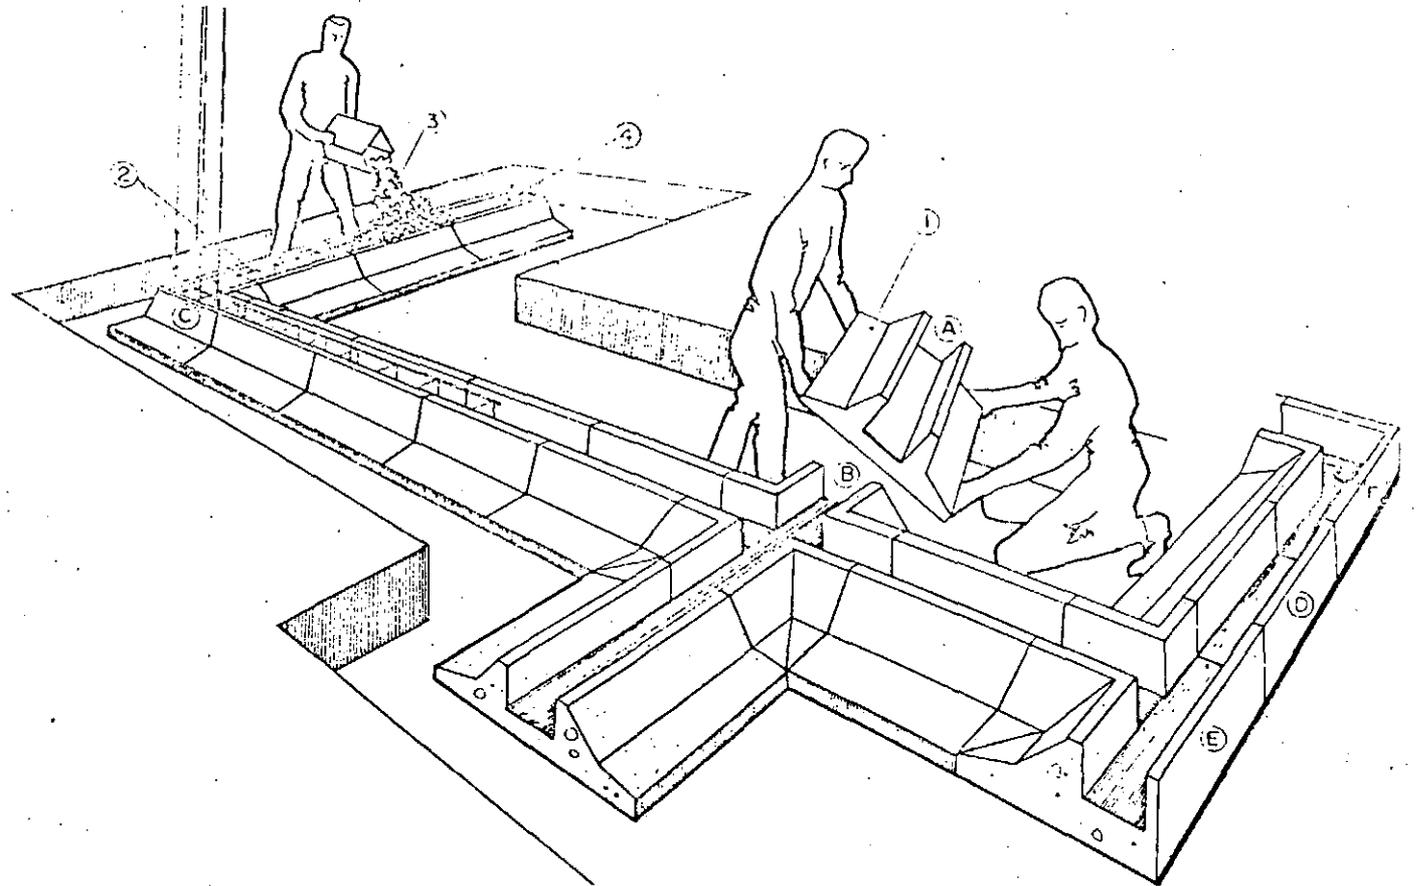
Tipos de "Zapatrabe" de Cimbracet y proceso de colocación. *Tipos:* A. Para tramo recto de muro, intermedio. B. Cruce y "T" para muro intermedio. C. Esquina para muro de colindancia. *Proceso:* 1. Colocación de "Zapatrabes" en cepas. 2. Armado de dalas de repartición y castillos o columnas. 3. Colado de concreto. 4. Desplante de muros o paneles.
